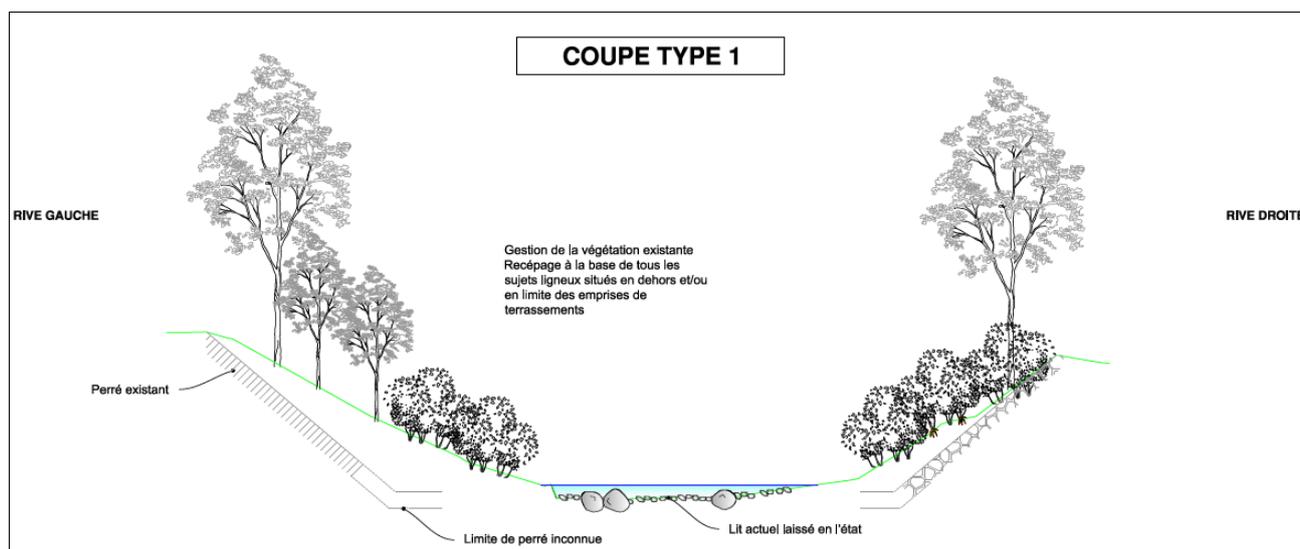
Coupe type 1: aval pont Rouge (Source: PRO Safège, avril 2018)
